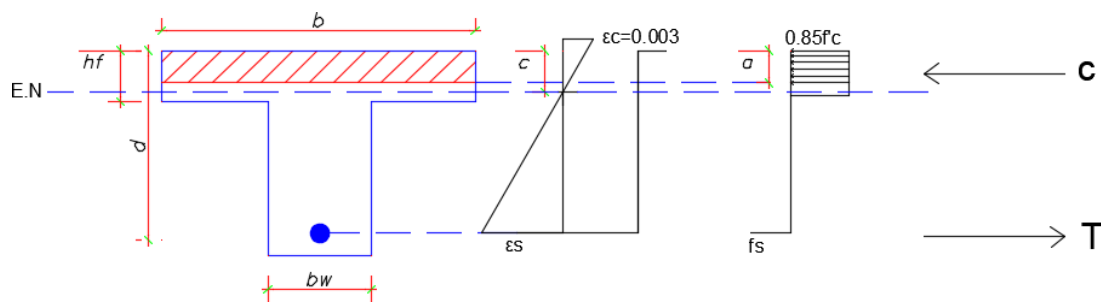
Ubicación del eje neutro dentro del patín de la viga
